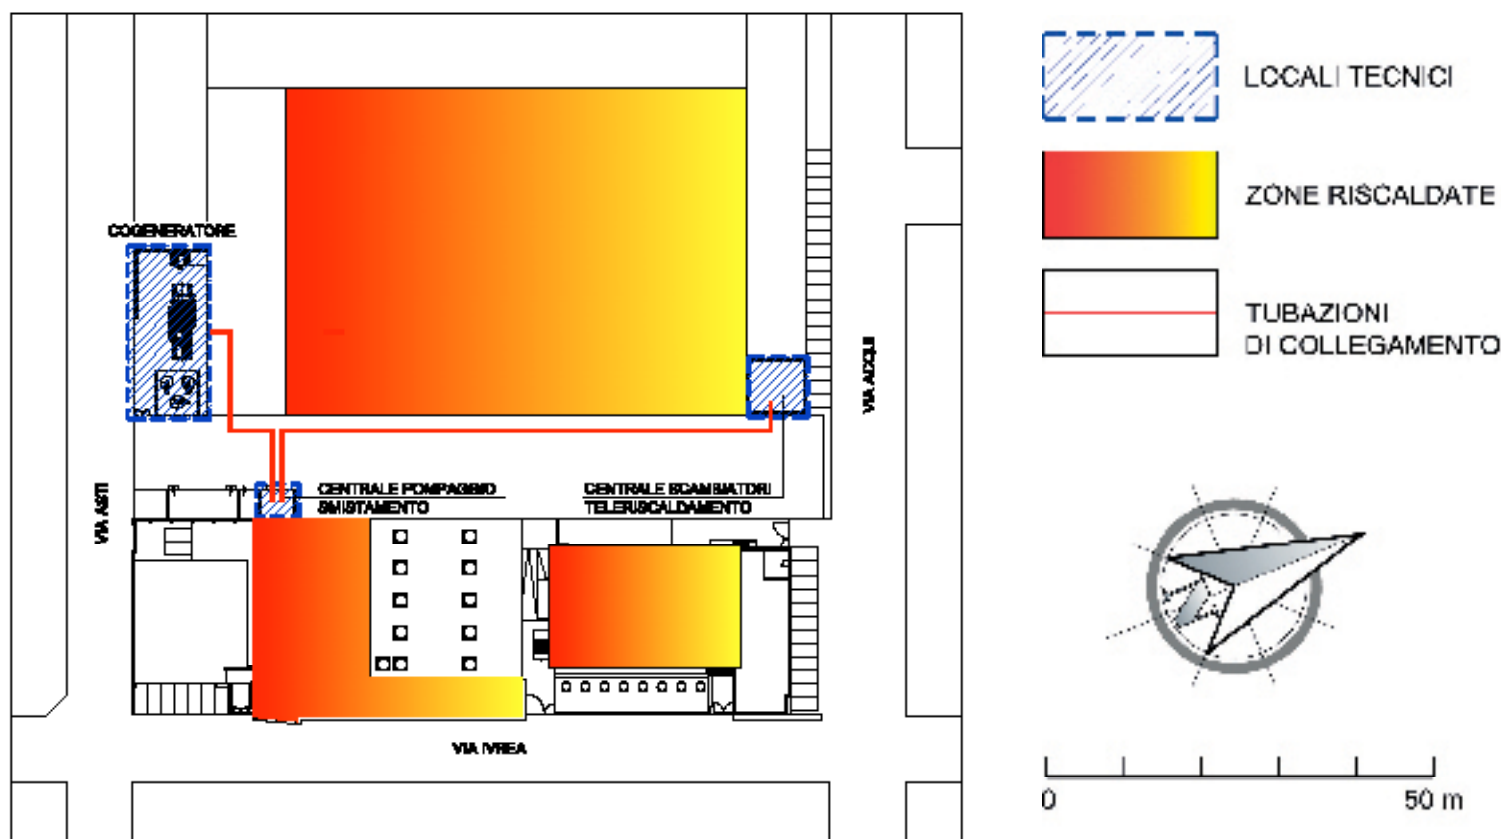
La planimetria generale 1:1000 del sito oggetto dell'intervento
